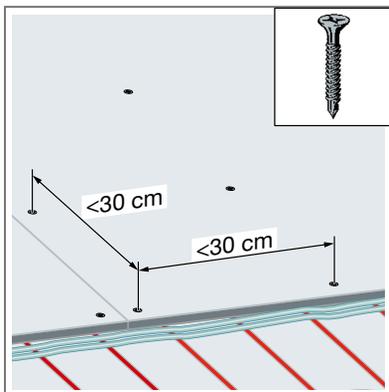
Gipsfaserausbauplatten mit Schnellbauschrauben befestigen
